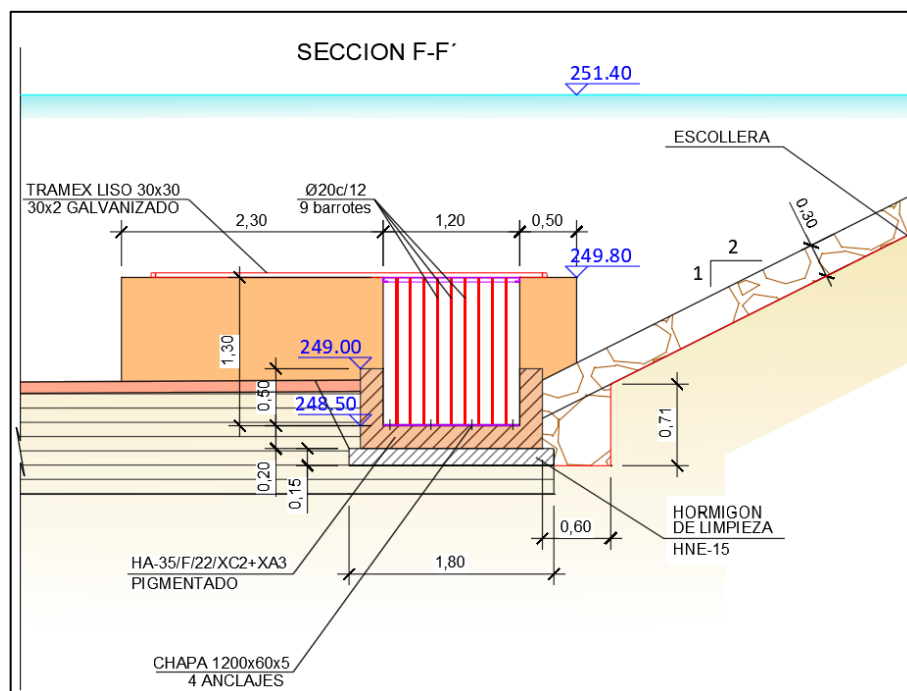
Vista de la sección de desembocadura de la estructura disipadora en la cuneta hormigonada.
